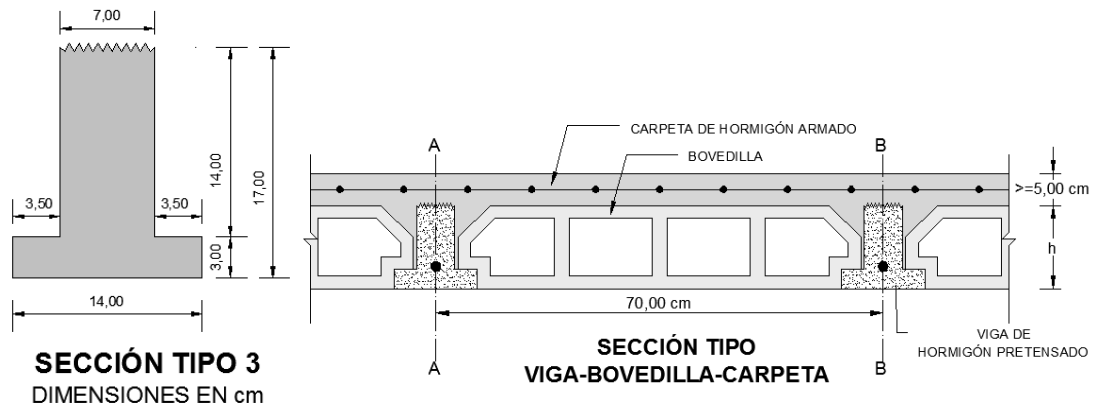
Sección Transversal inicial Viga de L=4,80 m.
